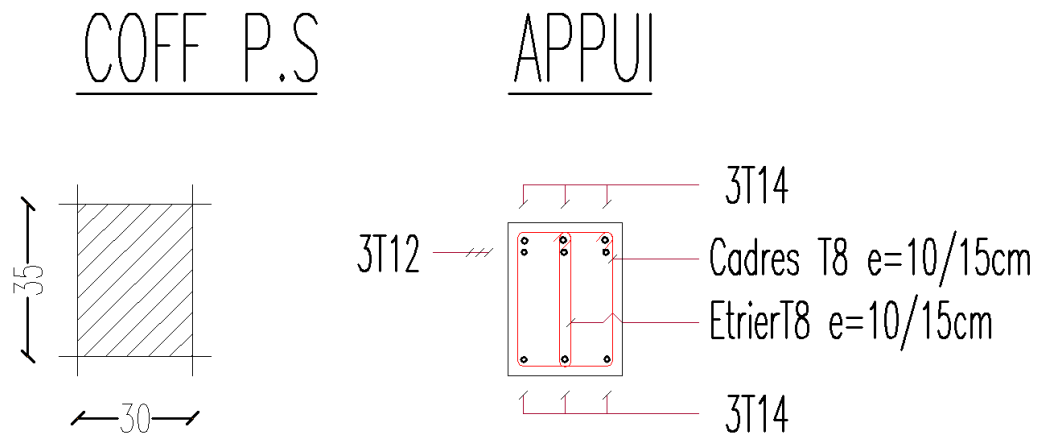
Schéma de ferrailage des poter scendare 30x35
